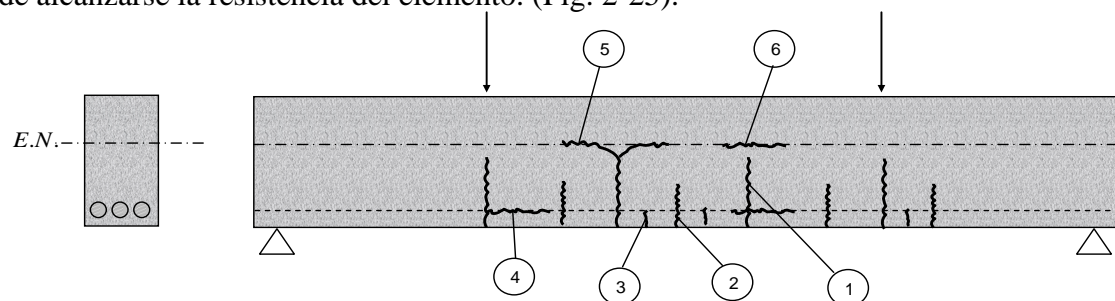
Configuración de fisuración de un espécimen sujeto a flexión (según Broms)
